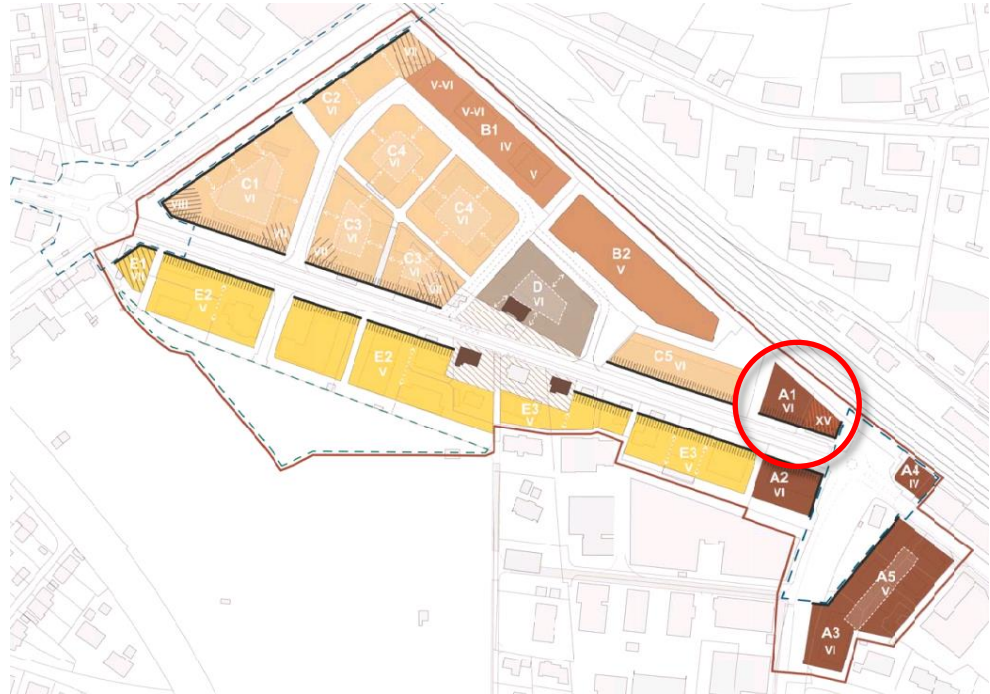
Darstellung Nutzung und Bebauung aus dem Masterplan Westliches Zentrum Gümligen (Baufeld A1 markiert)
